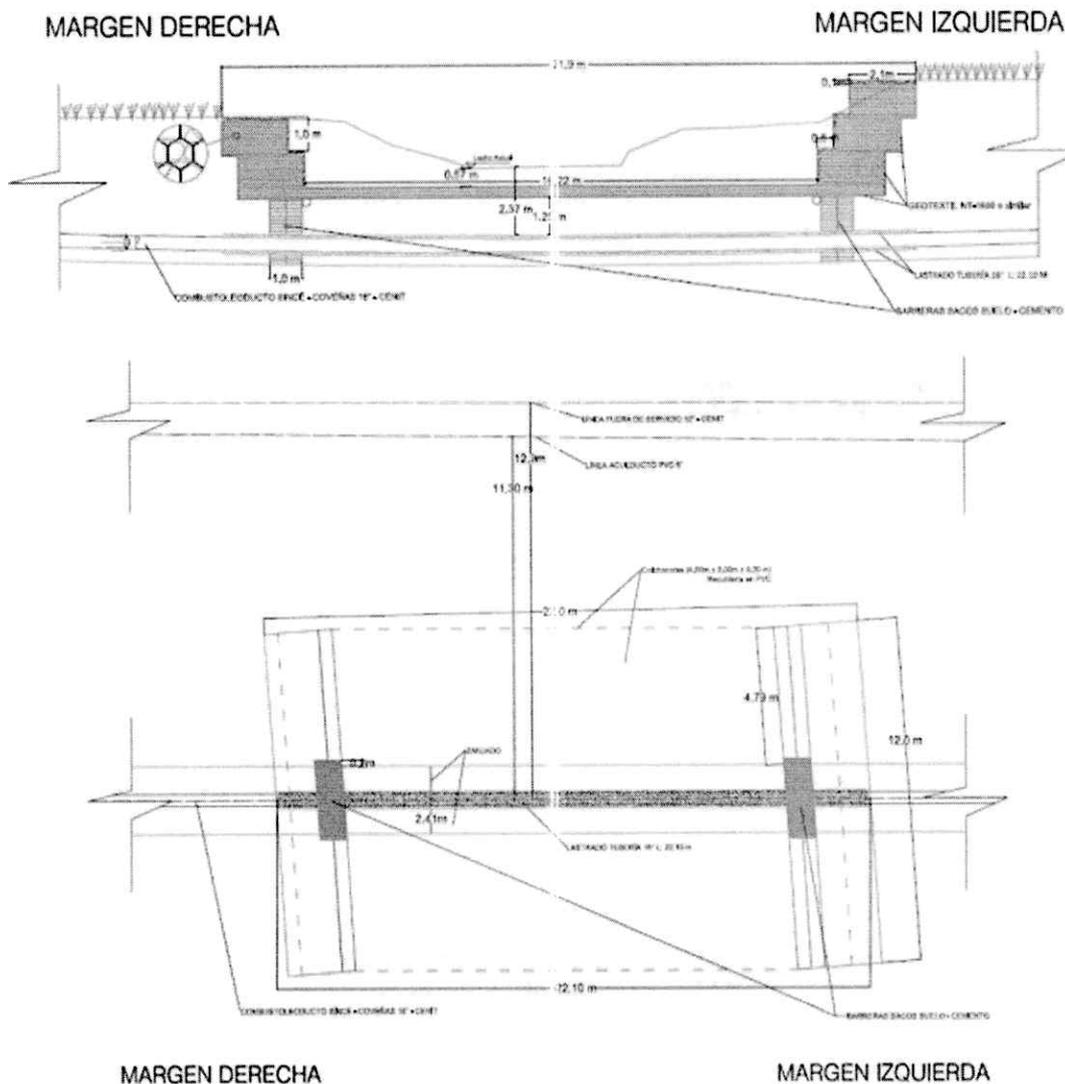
Vista Perfil – Planta de obras Km 275 +174
